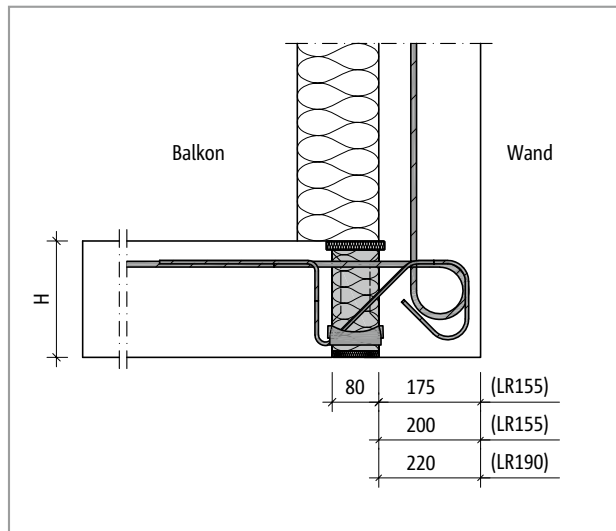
Schöck Isokorb® T Typ K-WO: Wandanschluss nach oben bei Außendämmung
